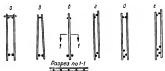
Сдвоенные сварные каркасы.
